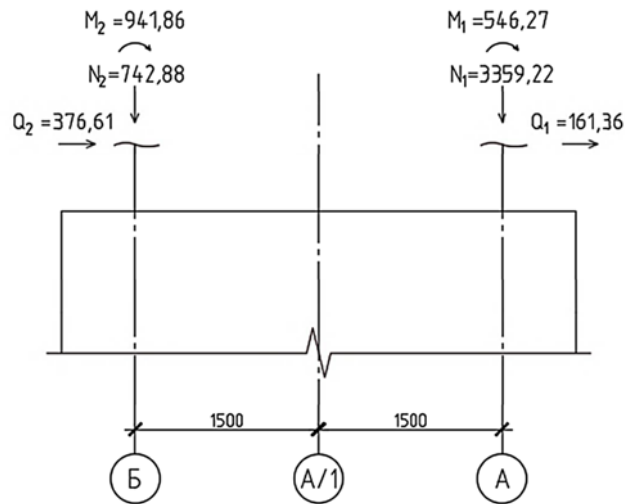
Схема передачі зусиль з гілок рами на фундамент
